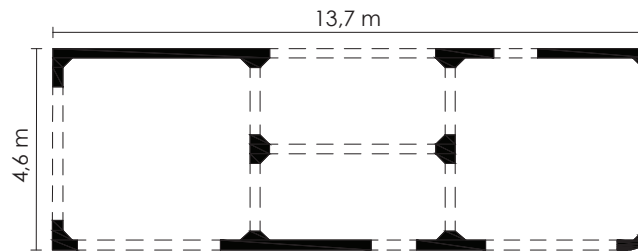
Pianta della campata; Fonte: elaborazione personale;
